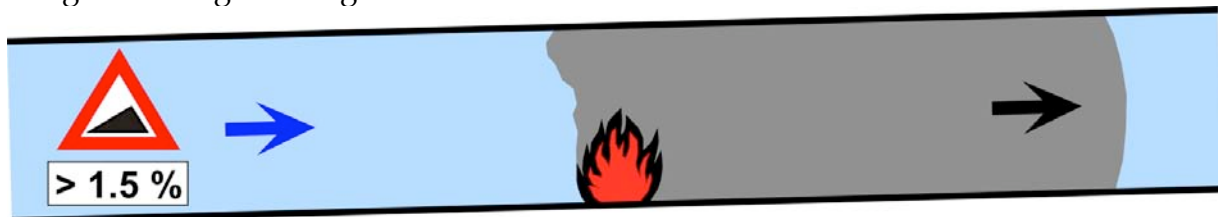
Längsströmung beim Betrieb der Tunnellüftung
